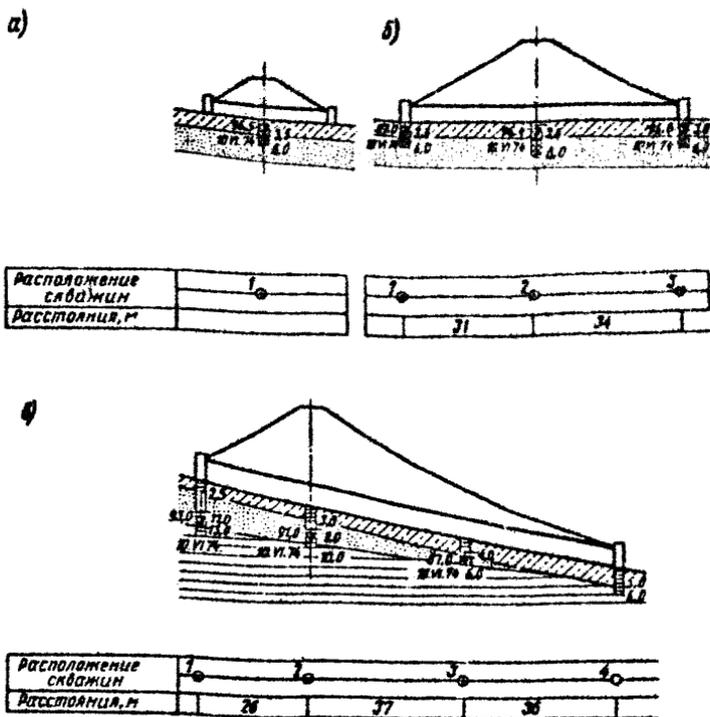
Разведка основания проектируемой водопропускной трубы при высоте насыпи: а - менее 12 м; б - более 12 м; в - на косогоре
